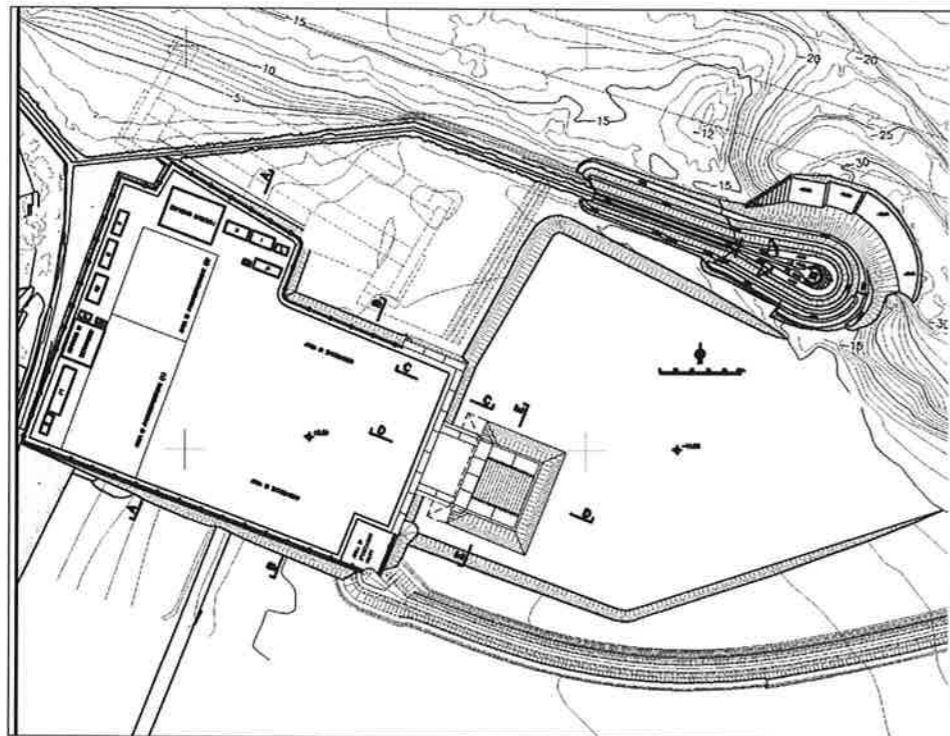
Il sito di prefabbricazione del cantiere di Malamocco: planimetria
